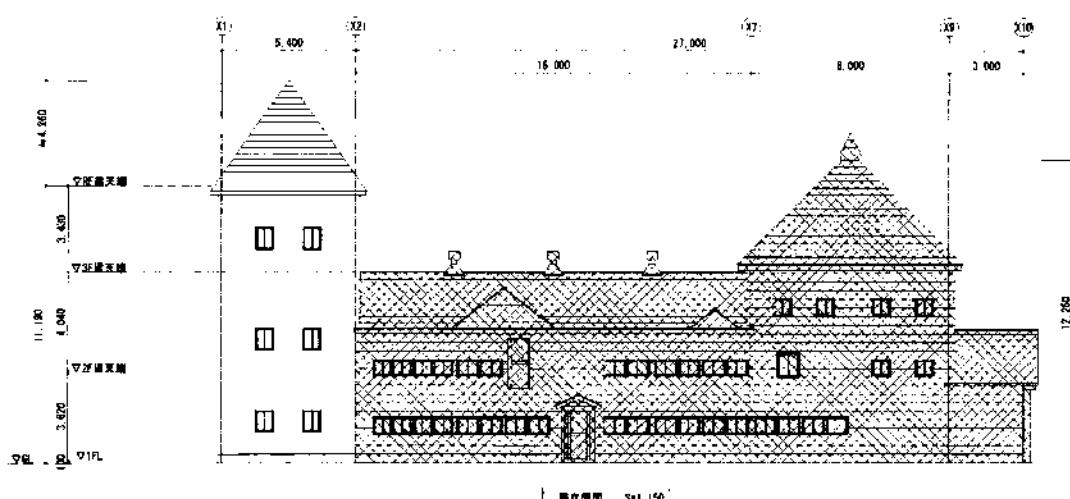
連続蒸溜工場 立面図 (株式会社シン技術コンサル提供)
